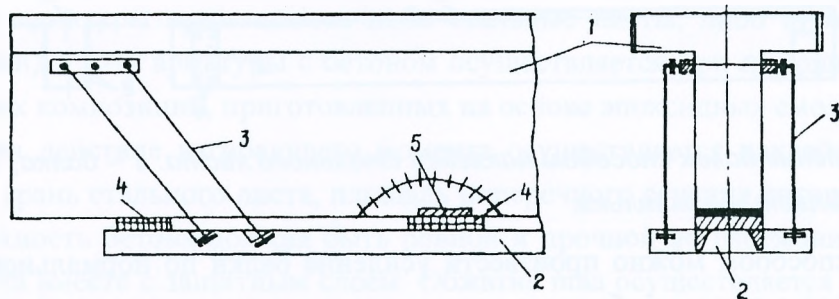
Усиление балок приваркой швеллеров: 1 – балка; 2 – швеллер; 3 – тяги; 4 – опорная пластина; 5 – коротыши.
